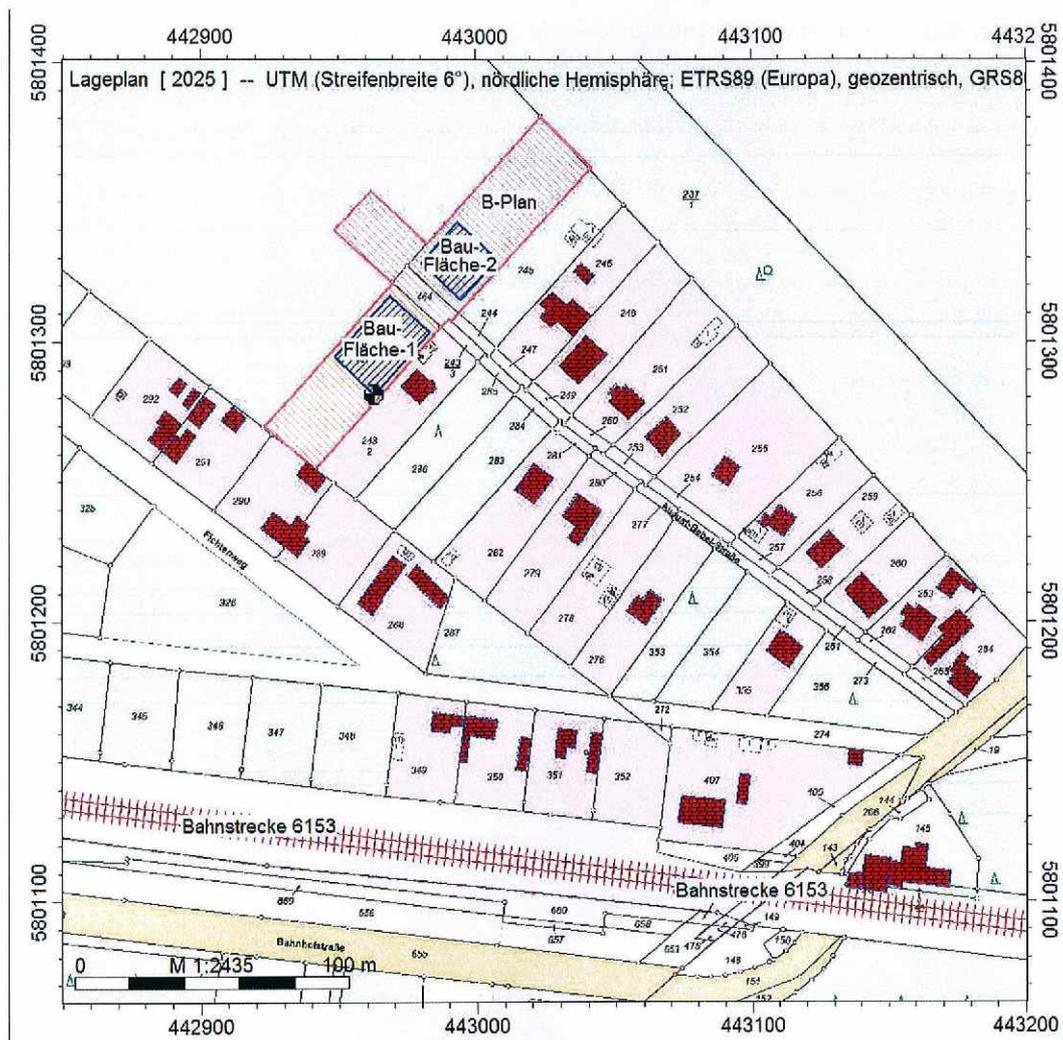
Standortsituation mit Geltungsbereich des B-Plans und benachbarter Bahnstrecke
